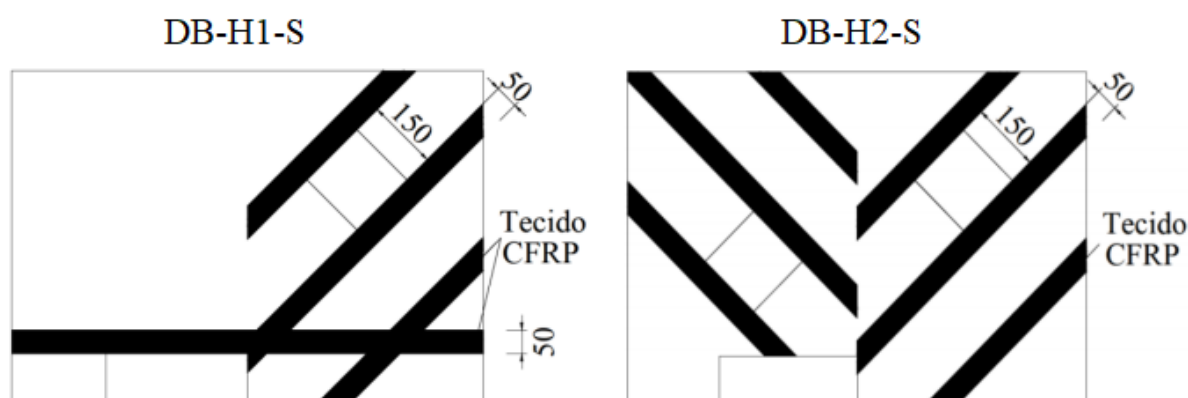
Detalhamento do reforço ao cisalhamento/flexão das vigas DB-H1-S e DB-H2-S(unidade em milímetros). Adaptado de Neta (2019).
